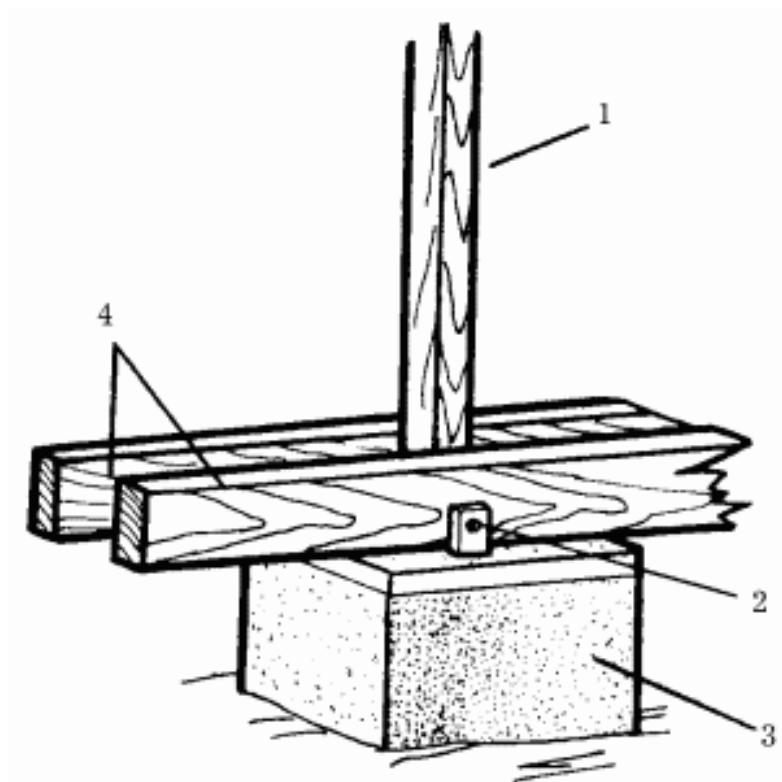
Столбчатый фундамент: 1 – стойка; 2 – анкер; 3 – столб; 4 – лаги.
